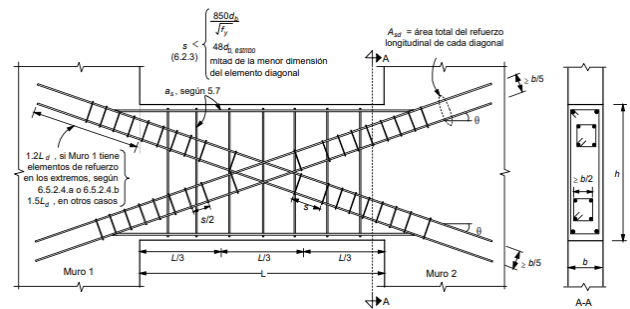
Refuerzo de una viga diafragma que une muros sujetos a fuerzas horizontales en su plano
